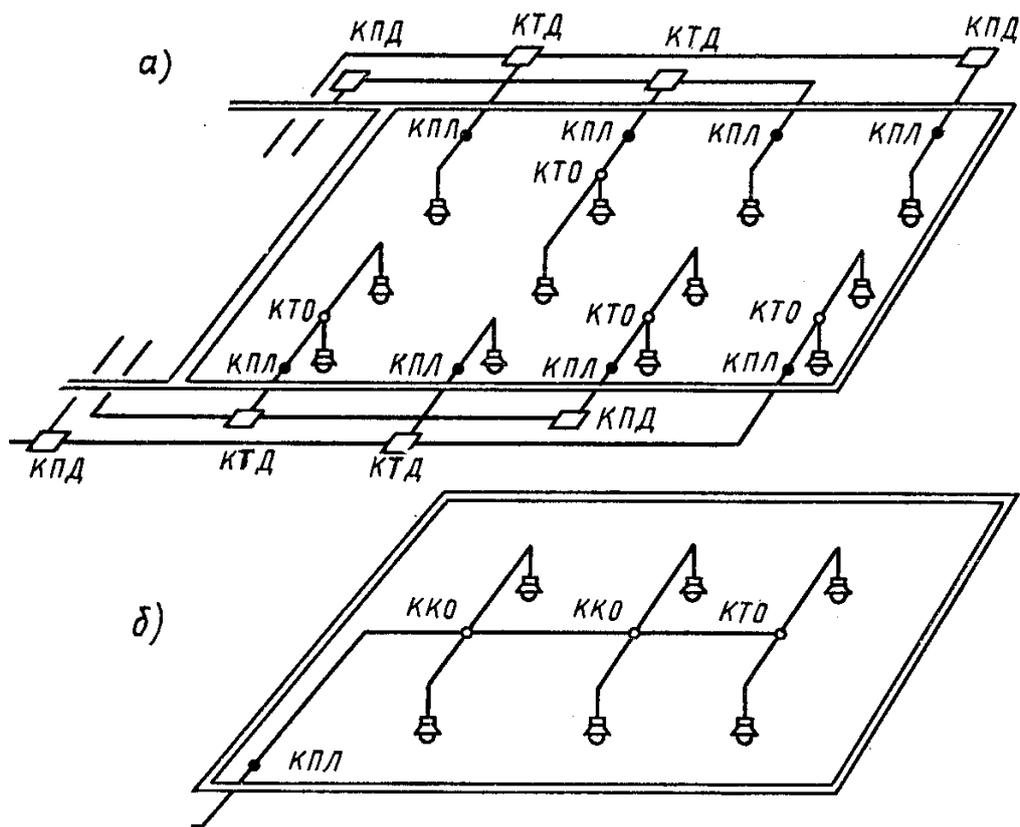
Разводка трубопроводов осветительной сети в помещениях со взрывоопасными зонами: а - класса В-1; б - классов В-1а, В-1б, В-11 и В-11а (установка коробок КПЛ только в зоне класса В-1а)
